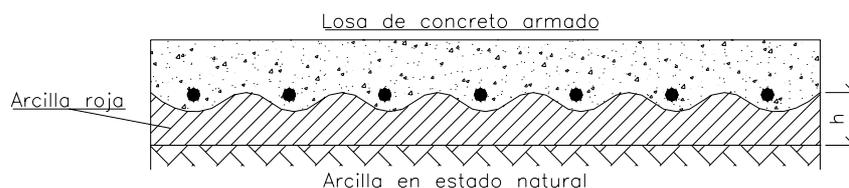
Losa de concreto armado en la capa de arcilla tratada.
